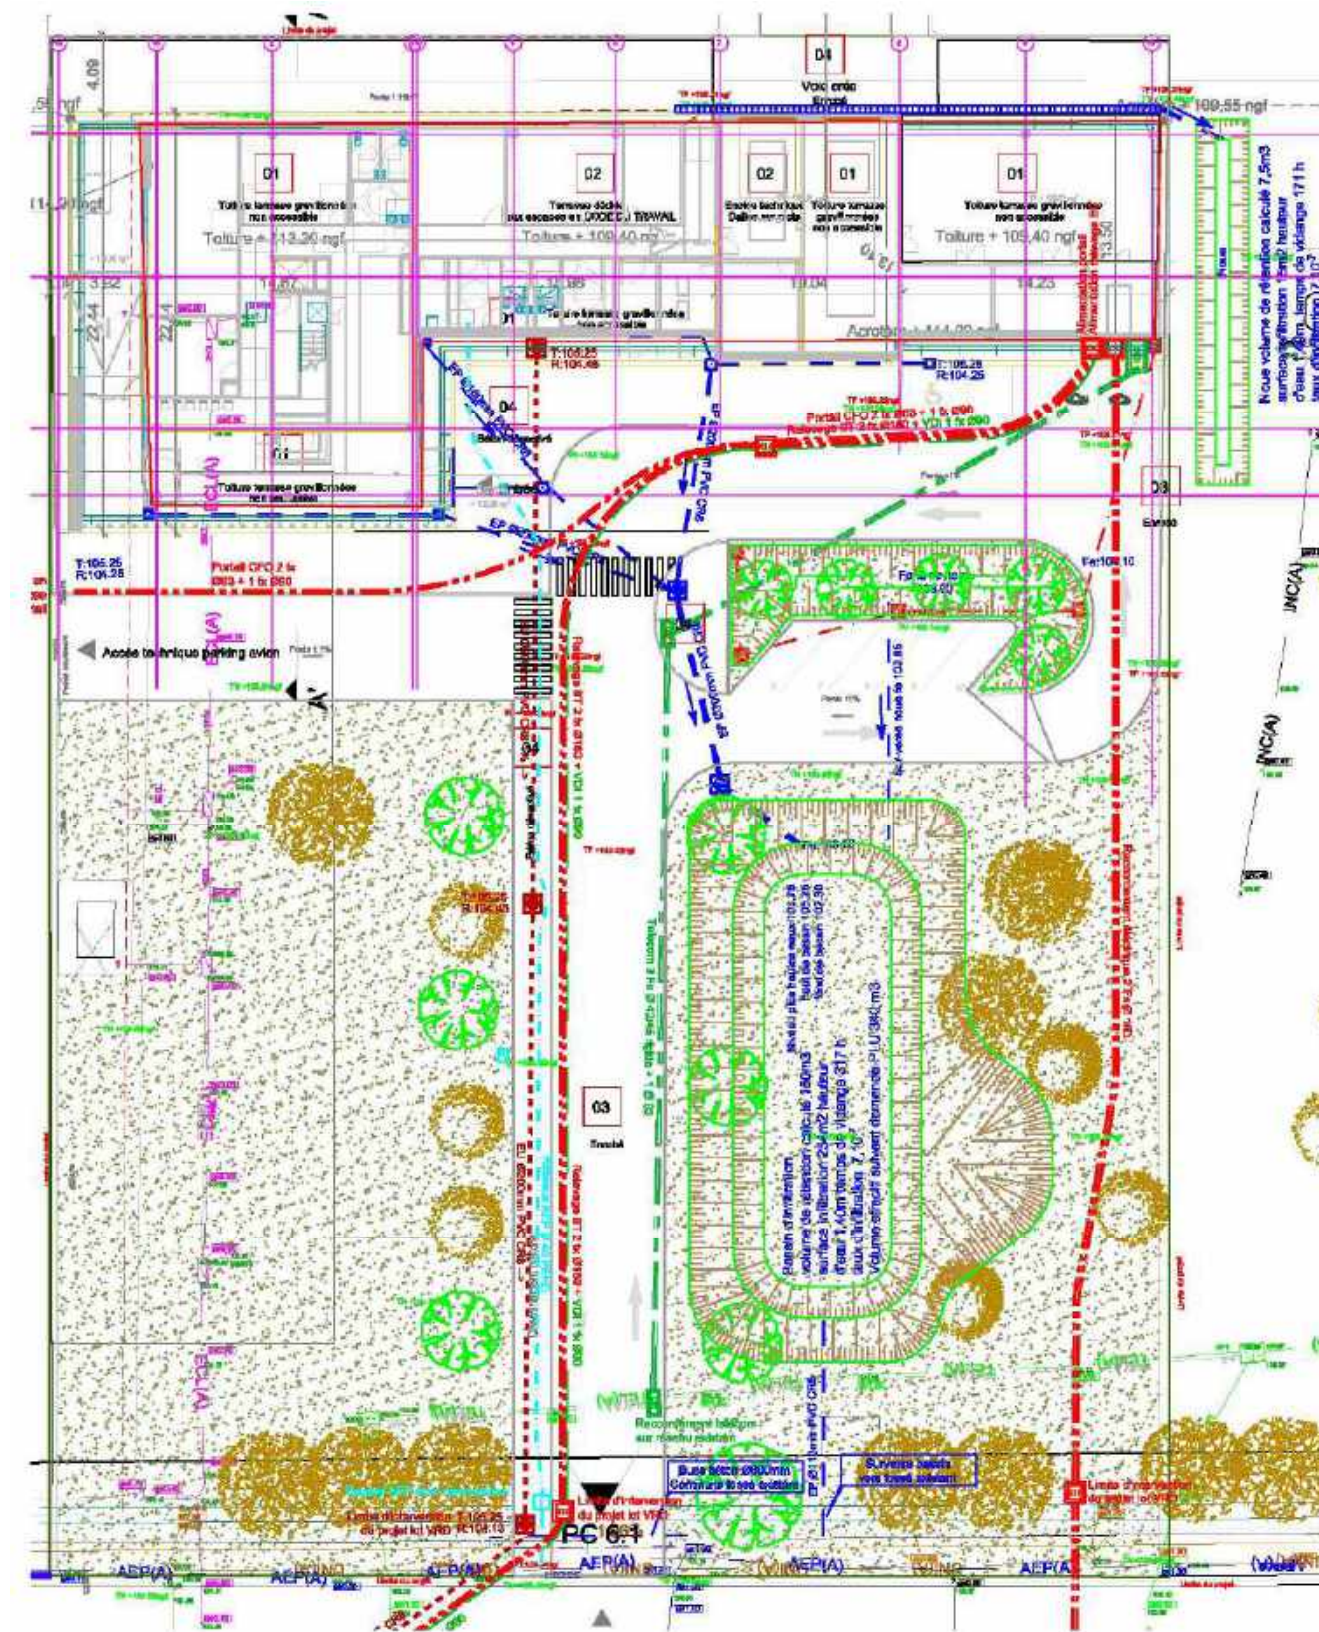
Plan d'assainissement du bâtiment à programme mixte (Source : Note hydraulique_Edeis)
